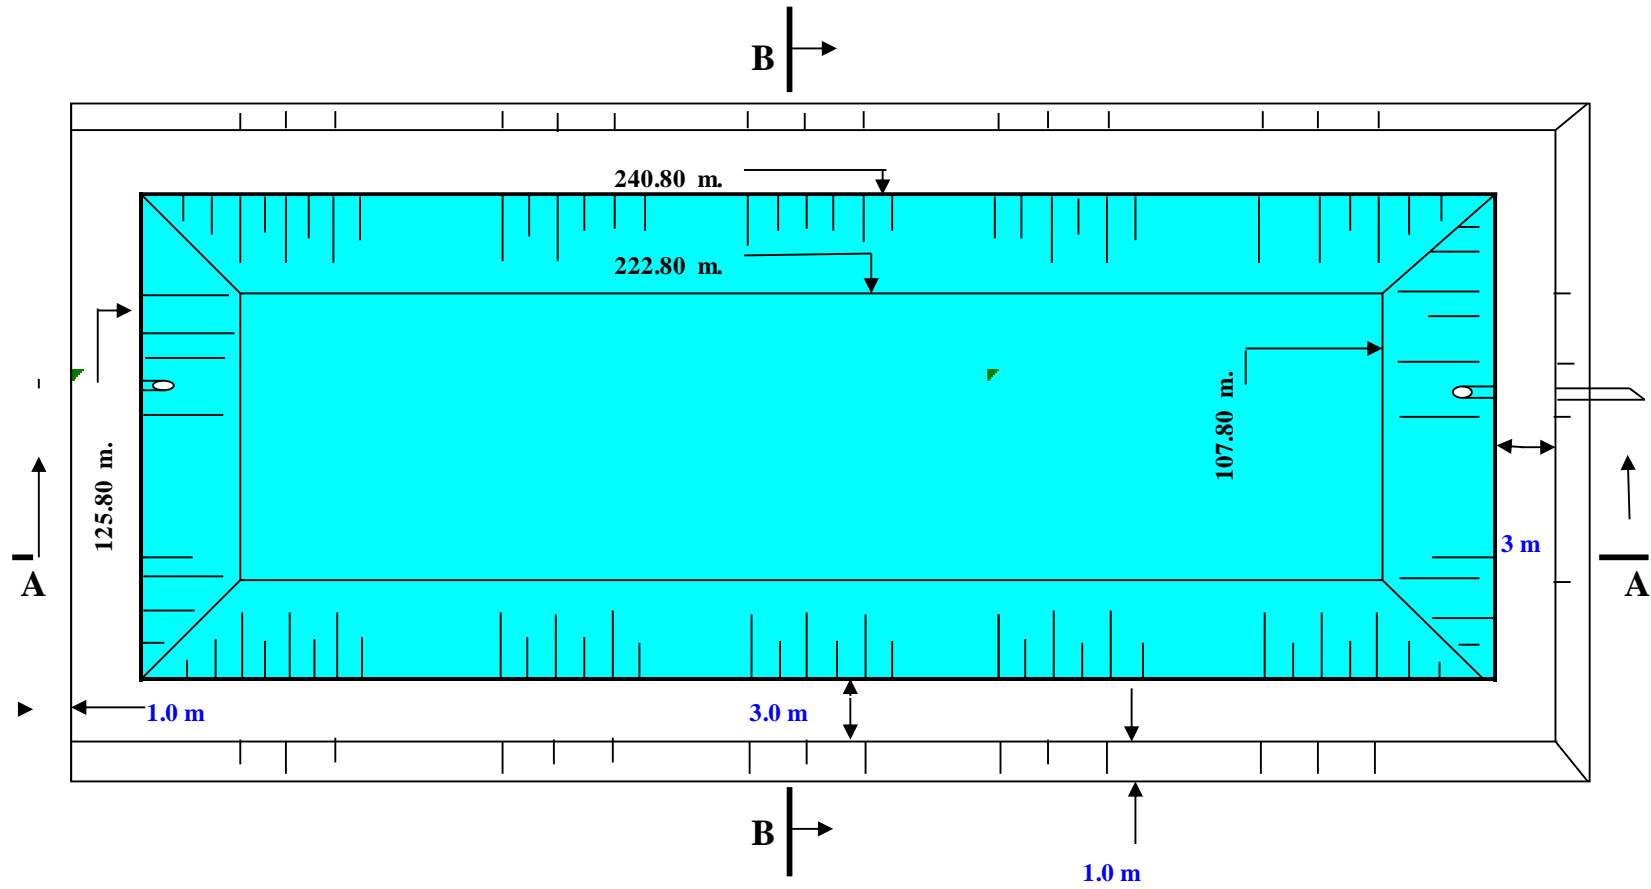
Dimensiones laguna primaria – Detalle en Planta
